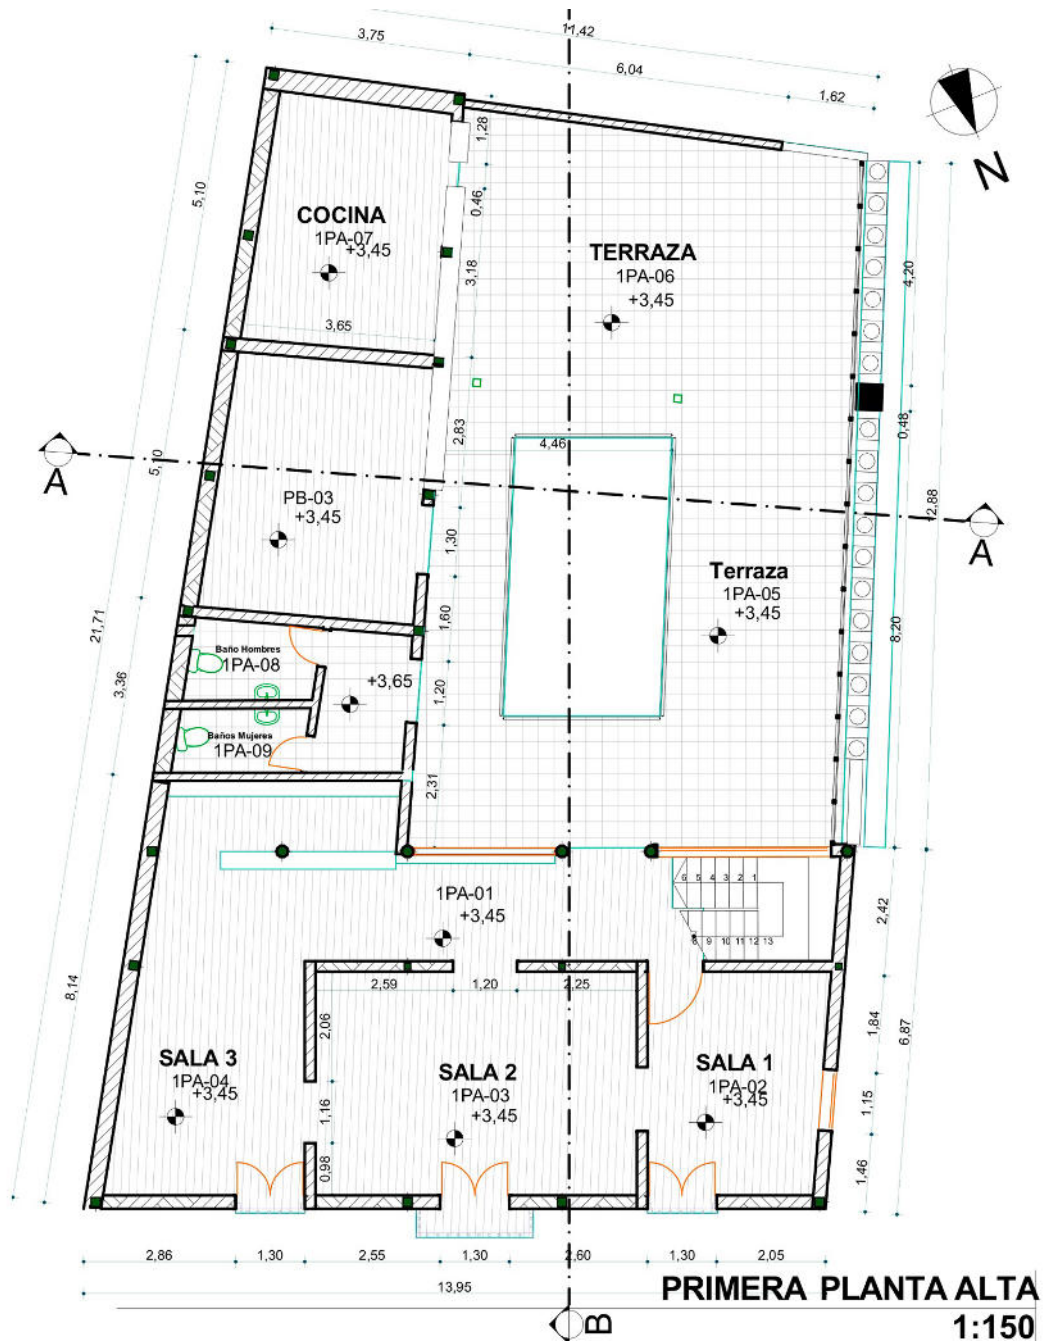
Planta y perspectiva 1ra planta alta
